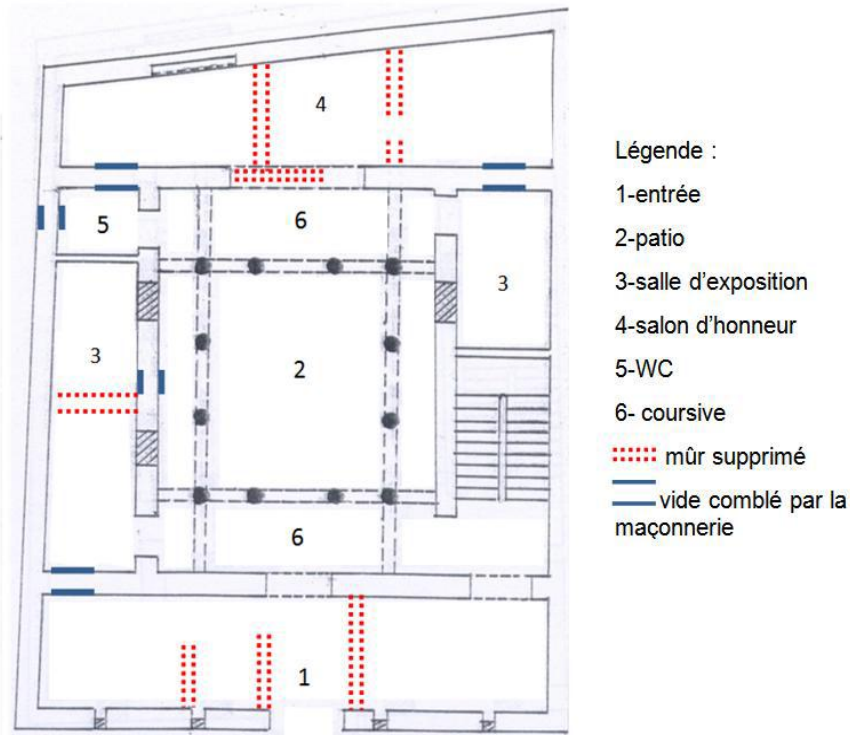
Plan schématique [plan R.D.C] de la maison du Kaïd après la Restauration
